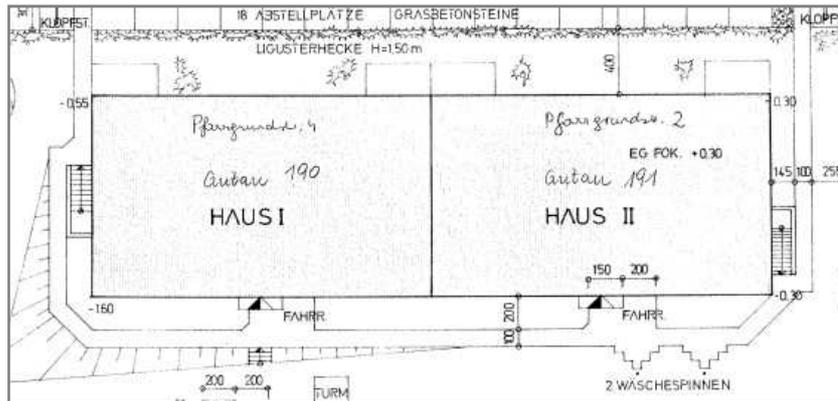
Grundriss Mehrfamilienwohnhaus¹⁵²
